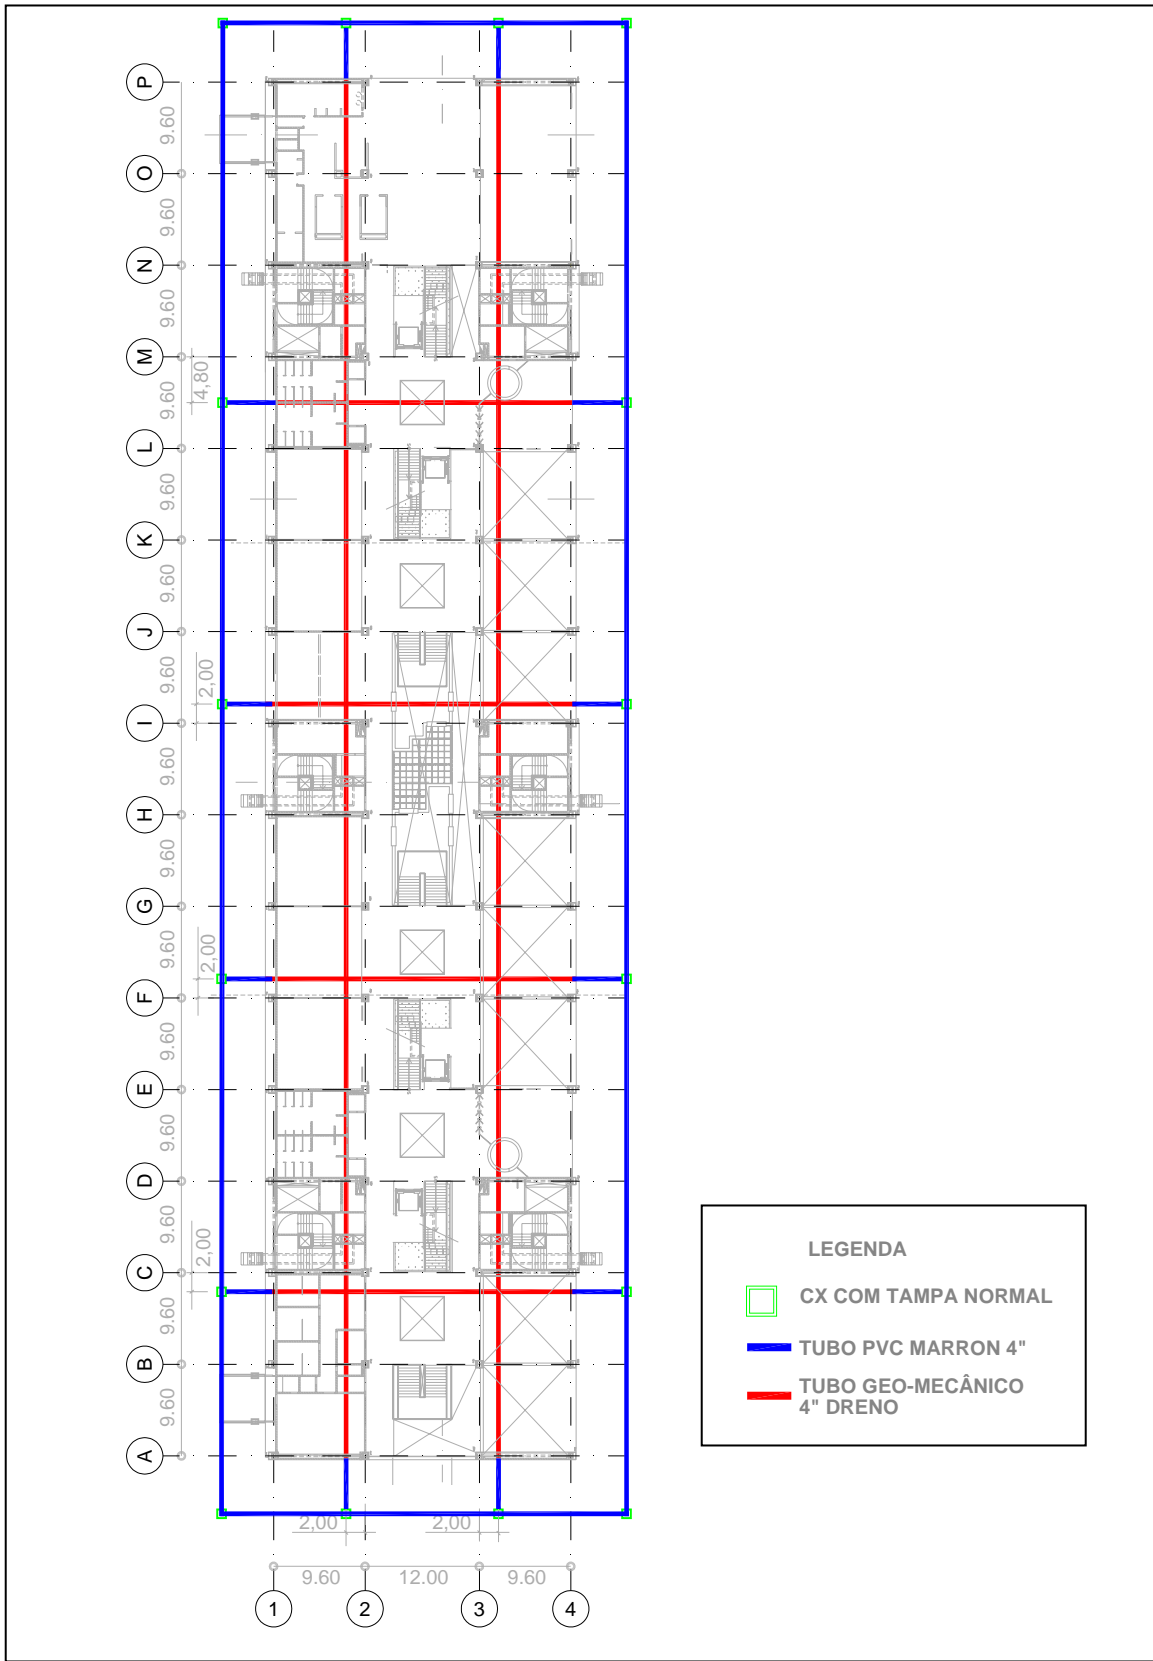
Planta de drenos horizontais do edifício I-1 (vista geral)
